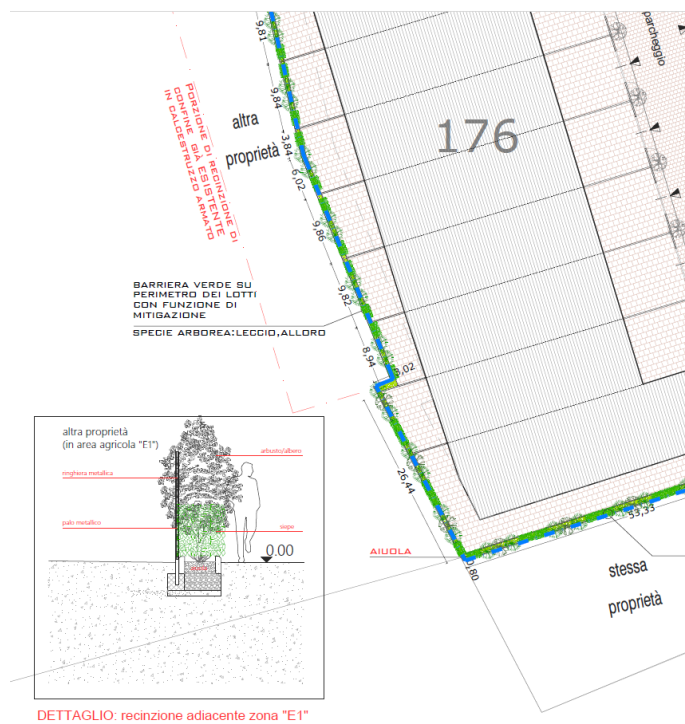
stralcio Tav.03– Progetto del sistema del verde_int._gen.2025
